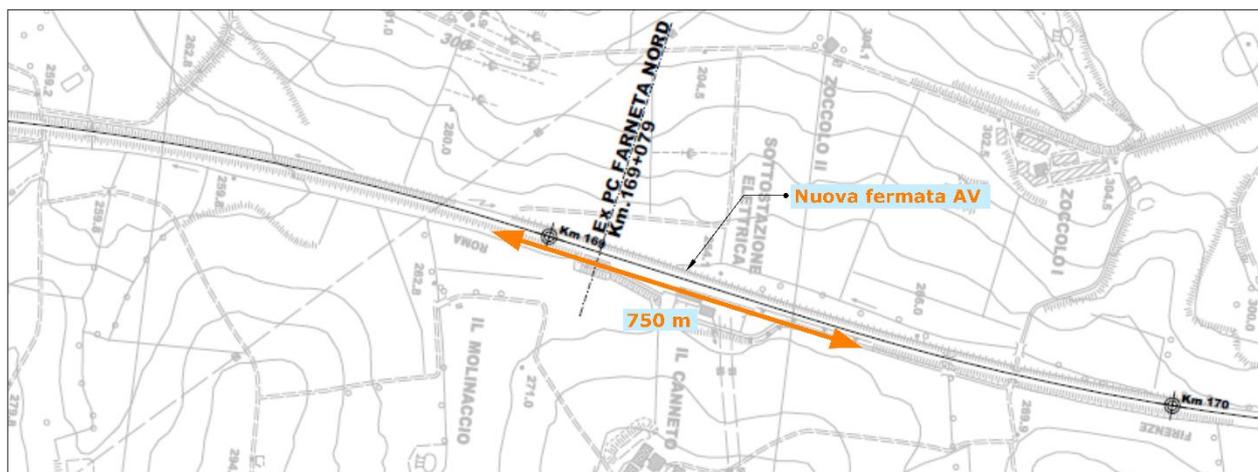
B. Planimetria della tratta Bettolle Farneta, compresa tra le pk 168,800 e 169,550. Fonte: RFI, tavola L514 - Km154 – 189.
